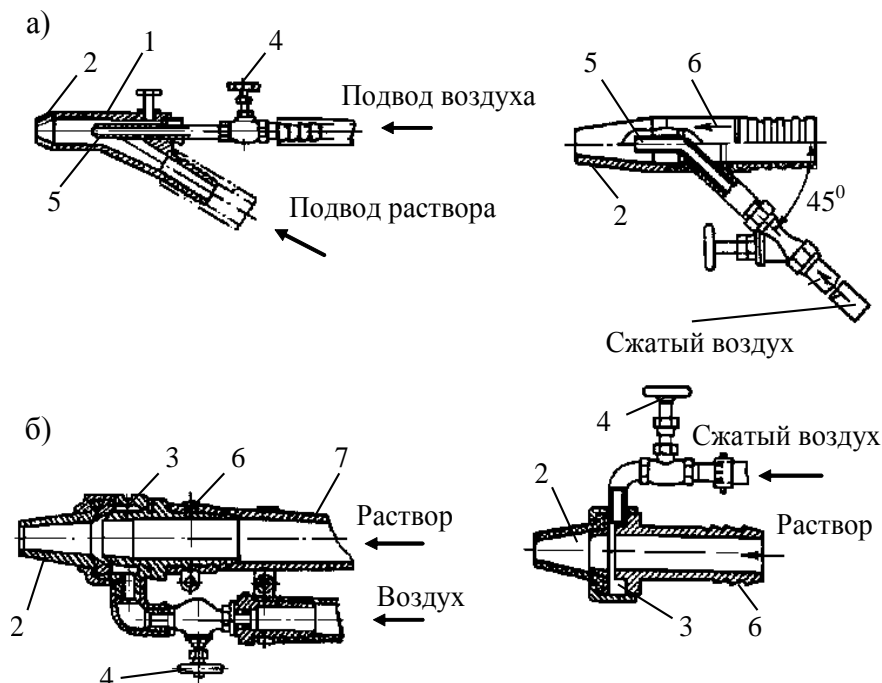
Пневматические форсунки: а – форсунки с трубкой; б – форсунки с кольцевой камерой; 1 – корпус; 2 – насадка; 3 – камера кольцевая; 4 – вентиль; 5 – трубка; 6 – штуцер; 7 – трубопровод
